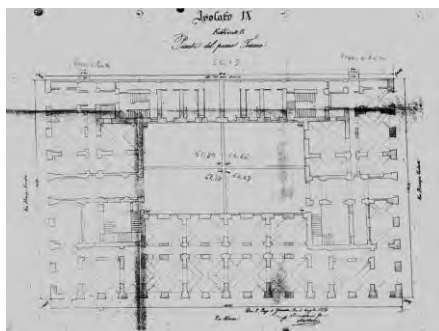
quartiere Esquilino Isolato IX pianta del pianterreno
